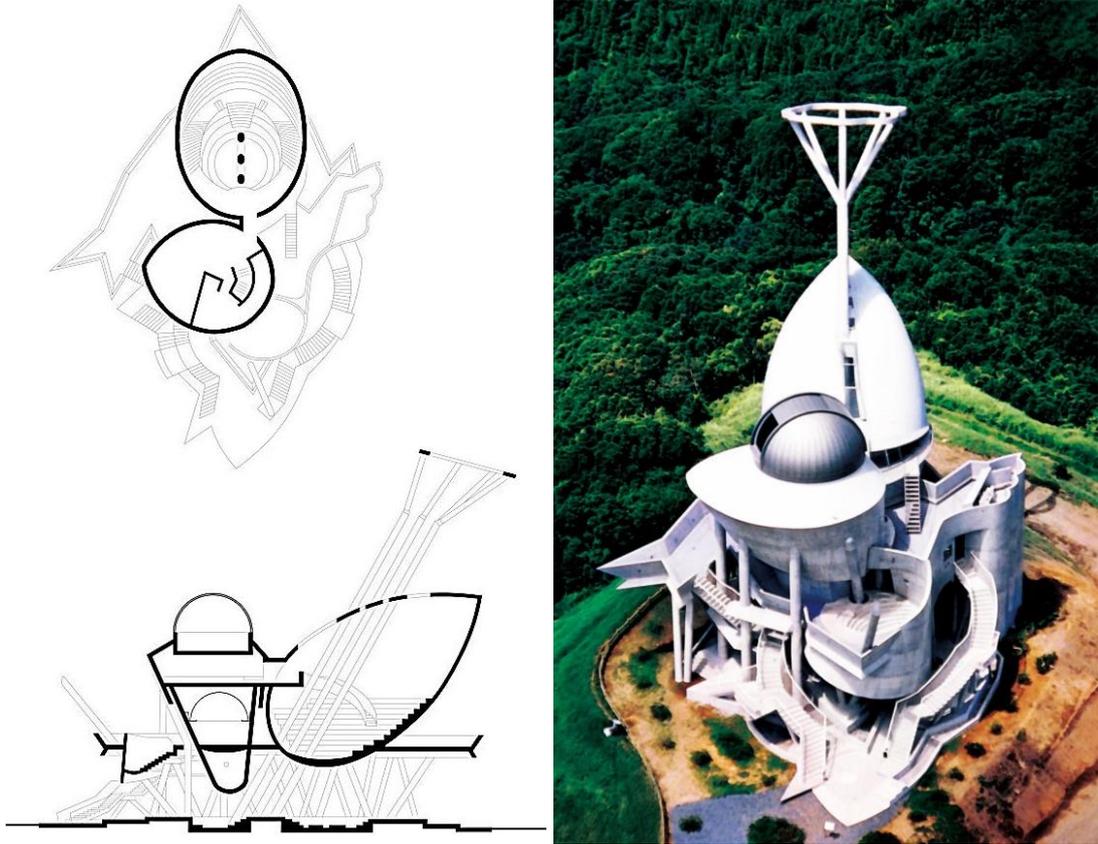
Centro Astronómico Teruhoku. Planta y sección.
